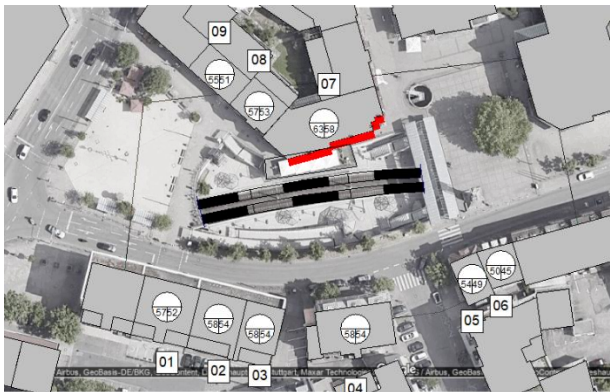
Lage Berechnungspunkte und Kennzeichnung anspruchsberechtigte Fassaden Bereich 2
